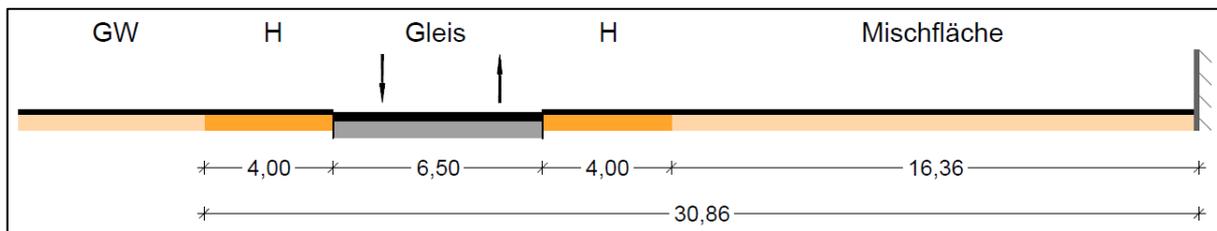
Hauptvariante 1, BS, geplanter Querschnitt Haltestelle Stadthalle (Angaben in Meter), Quelle: Voruntersuchung
